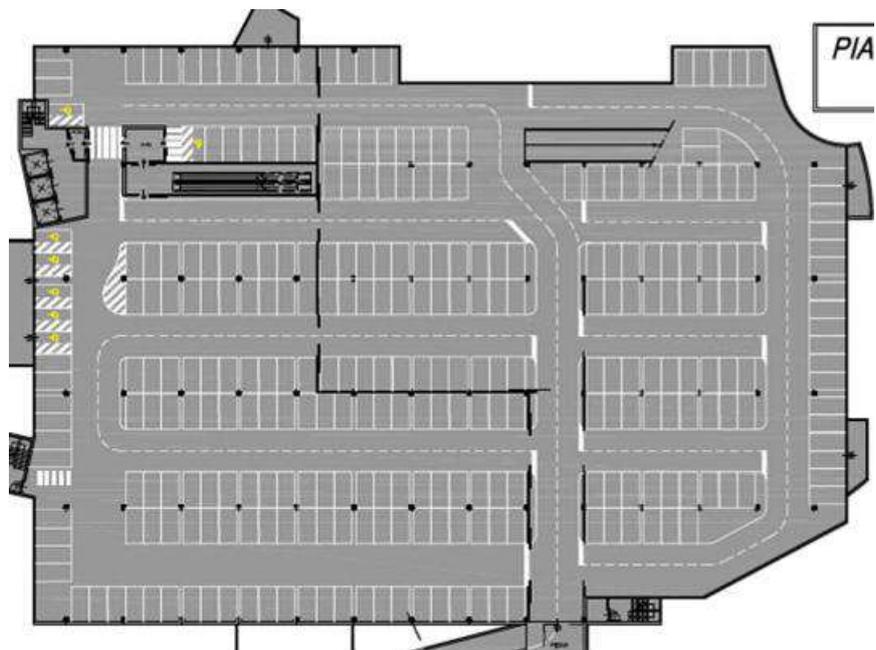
Individuazione aree di sosta – Parcheggio piano -2
